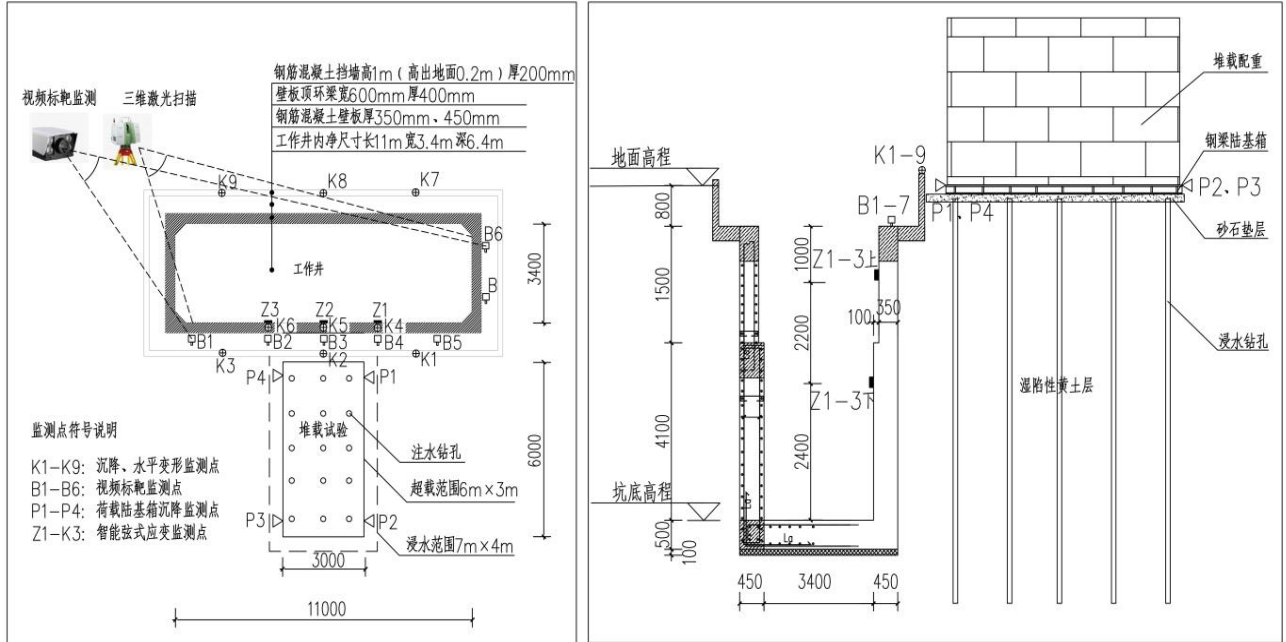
：逆作法钢筋混凝土壁板法施工基坑侧壁超载试验示意图
